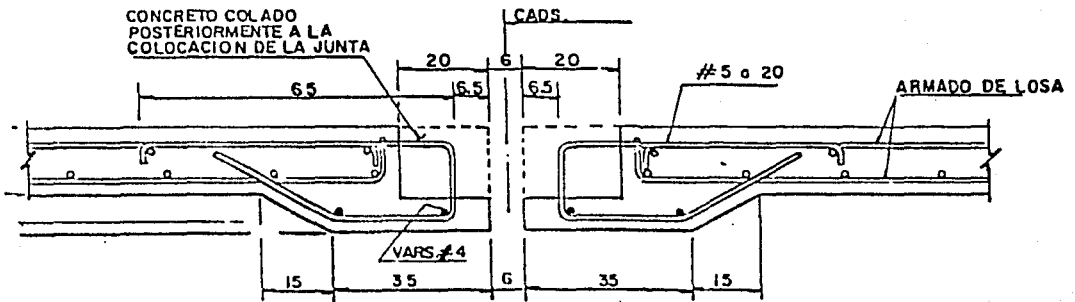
DETALLE TIPO DE PREPARACION PARA JUNTA EN LOSA.
